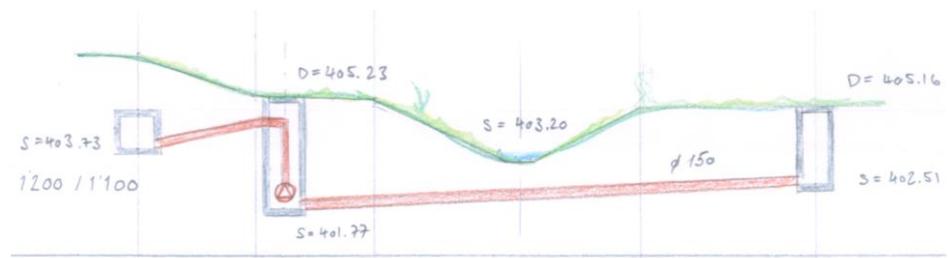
Skizze Abwasserleitung mit bestehendem Bach
